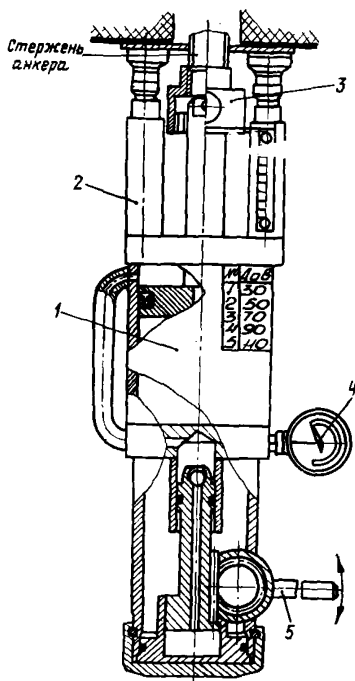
Гидравлический испытательный прибор (ГИП) для определения прочности закрепления анкерной крепи
